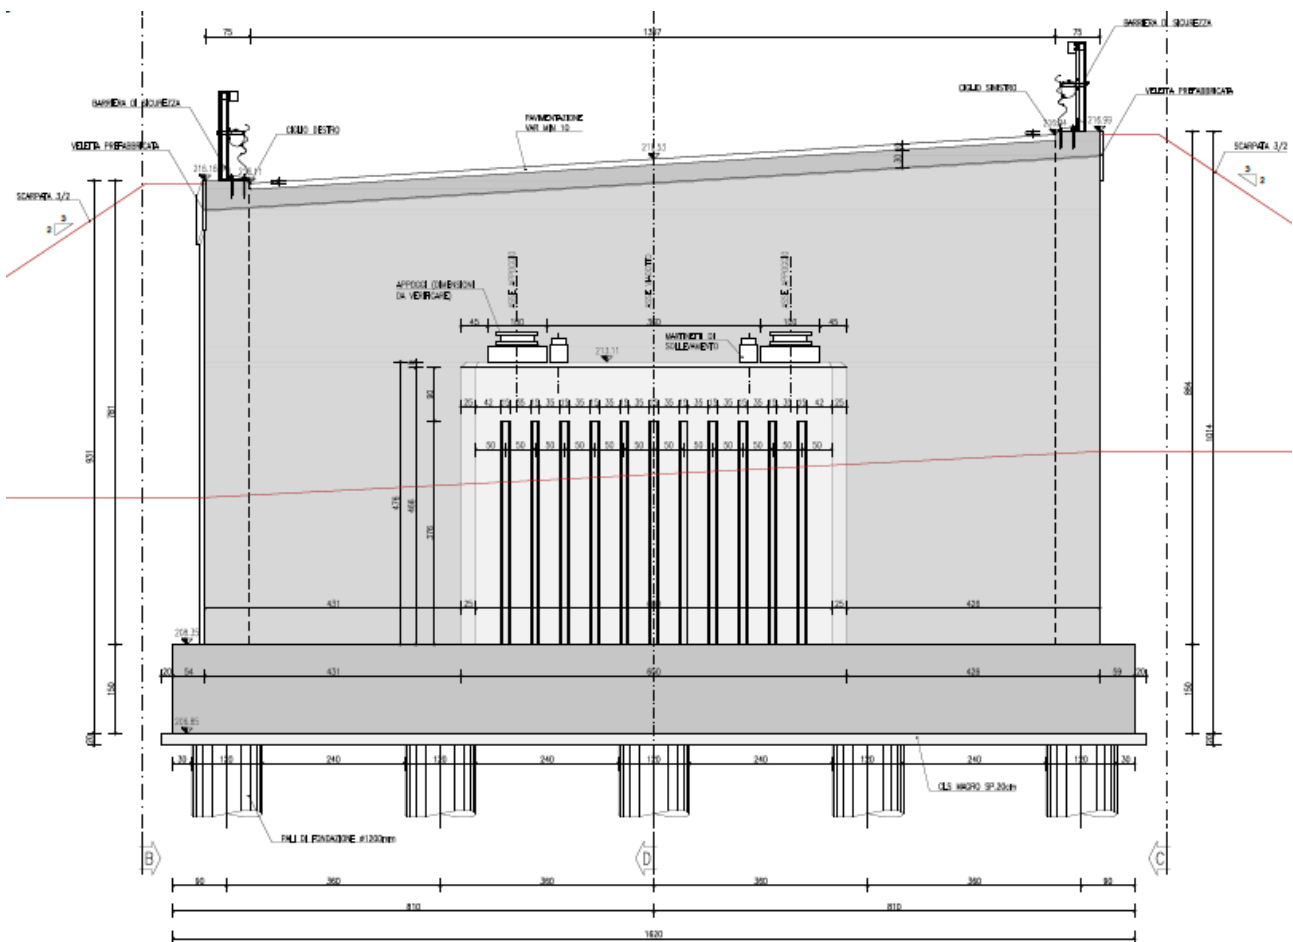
Spalla 1 – carpenteria elevazioni
